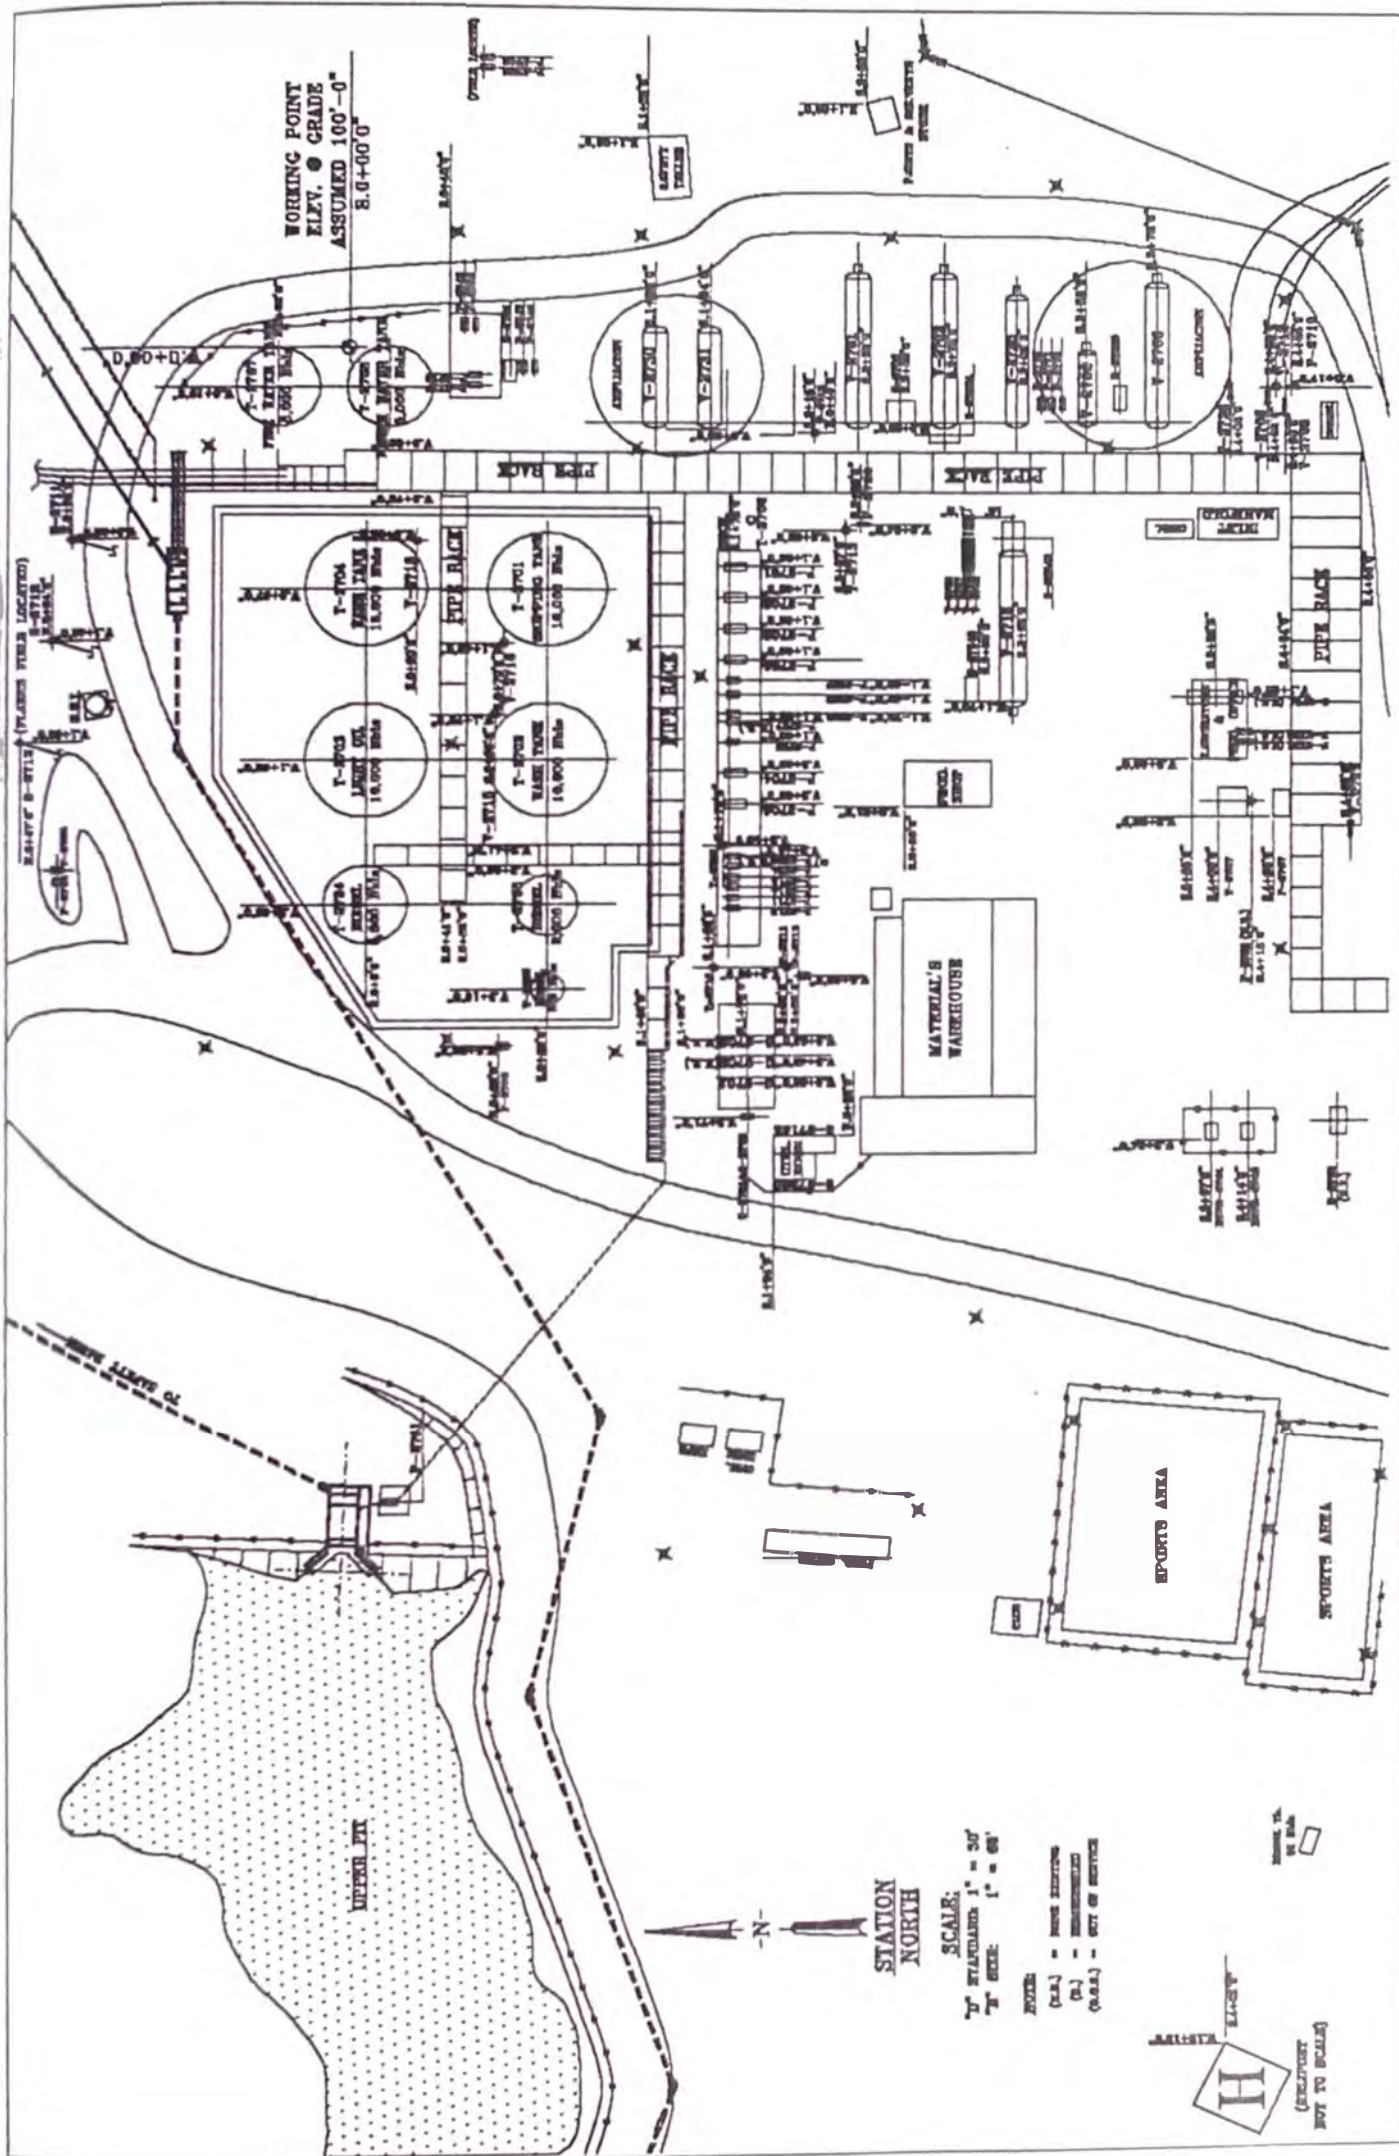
PLANO DE UBICACION DE EQUIPOS EN PLANTA DE JIBARITO
